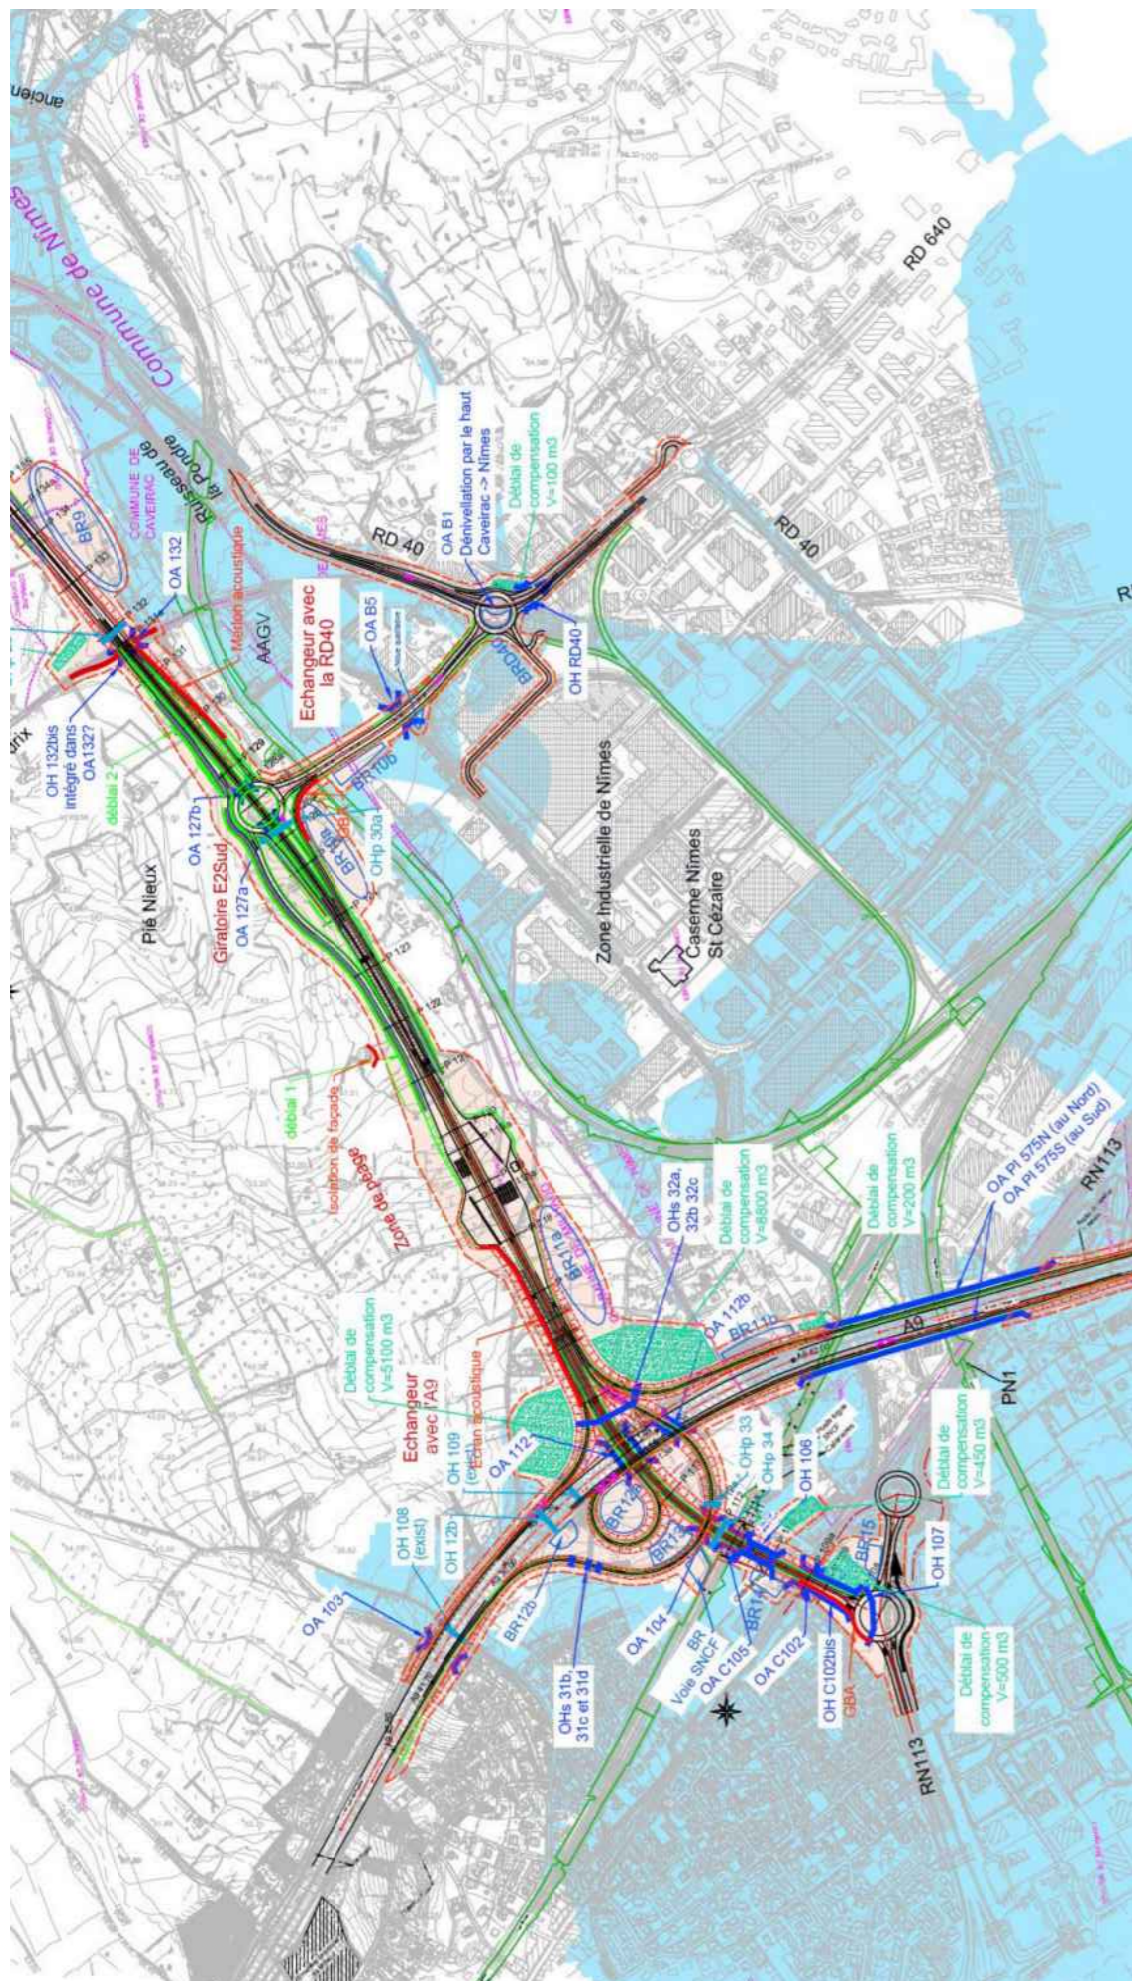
Plan de masse du projet - Secteur Sud, barreau et raccordement à l'A9 (Source : Présents, juin 2021)
